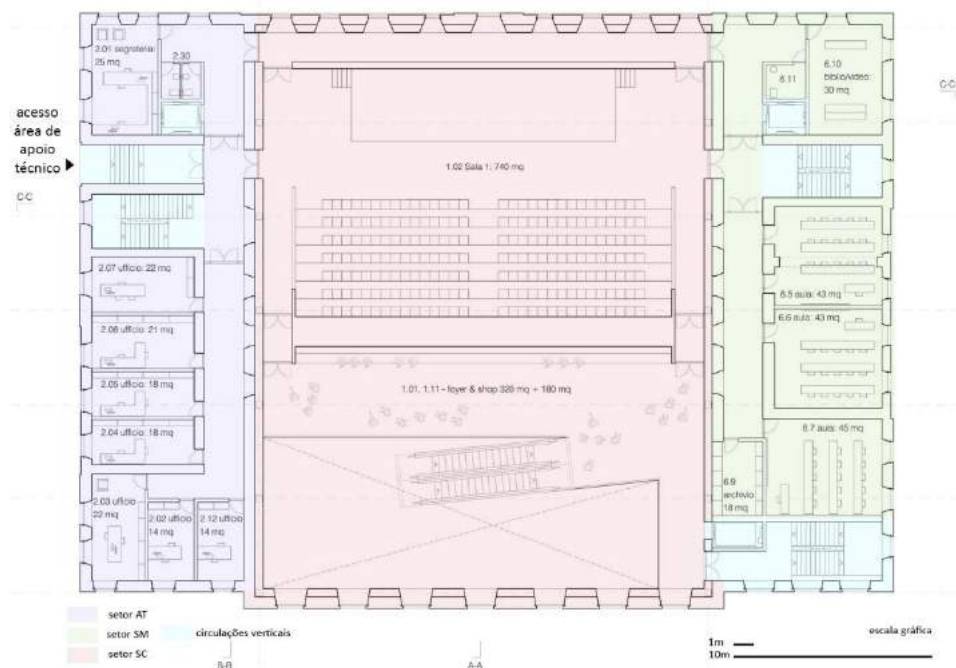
Planta do primeiro pavimento do Palazzo del Cinema
